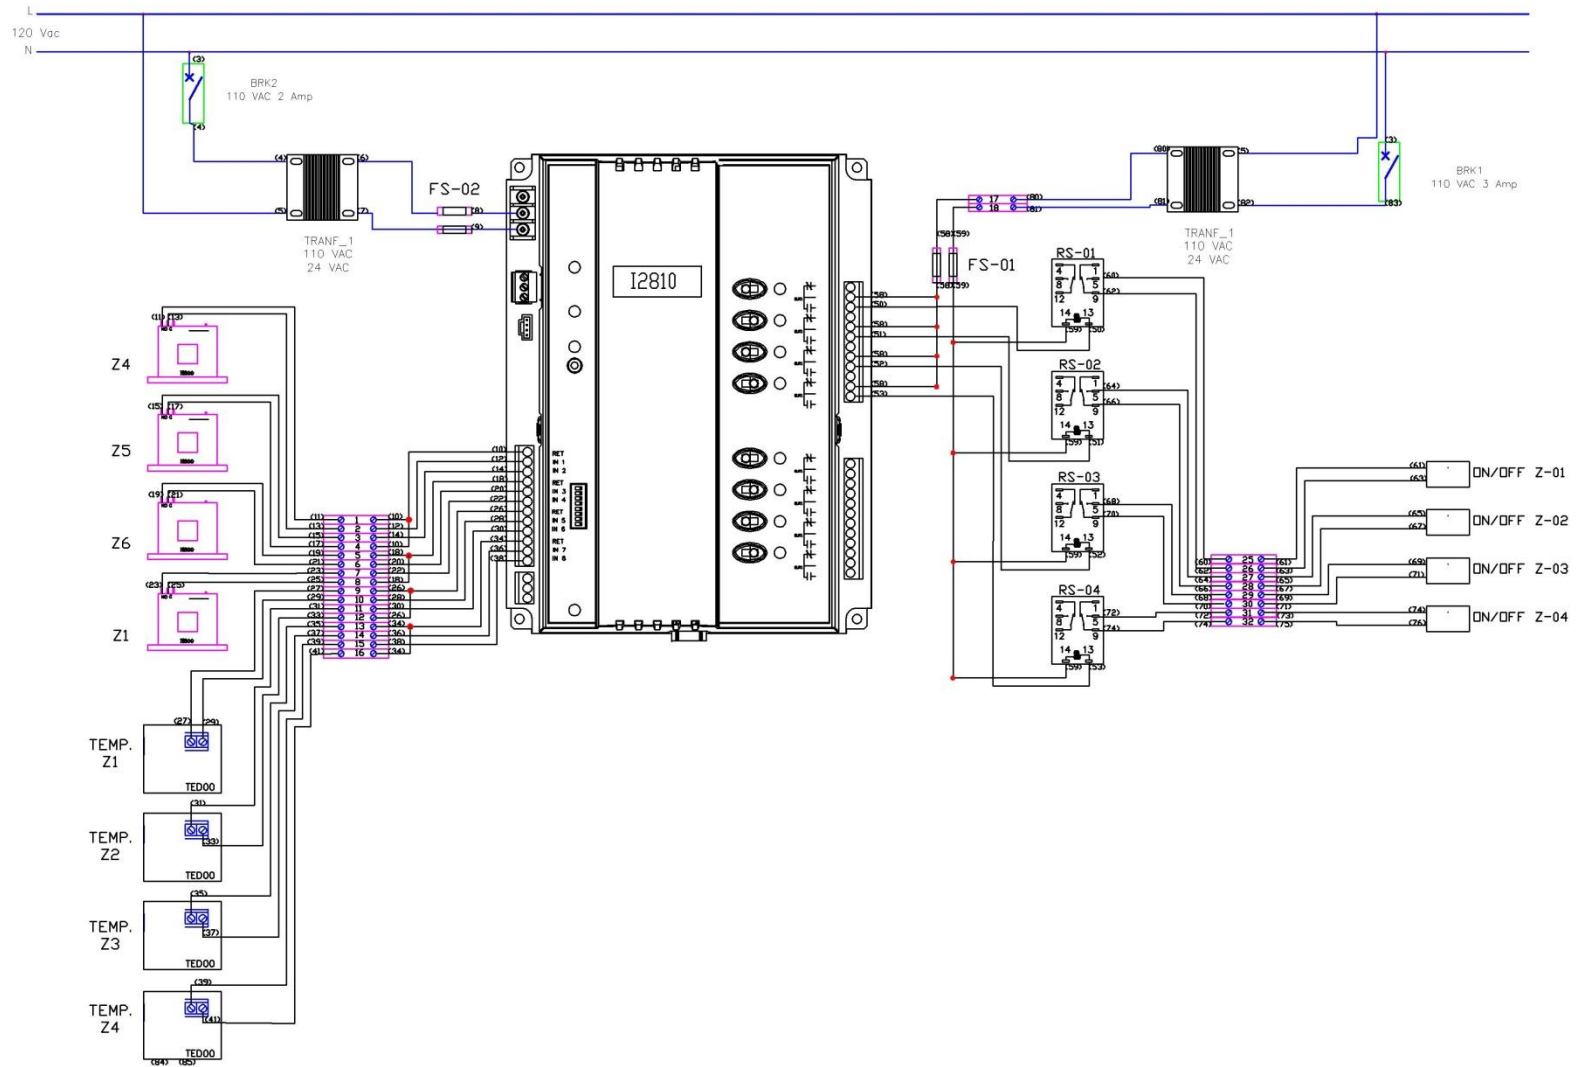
Plano de conexiones eléctricas Tablero UPB J 4 piso Torre Sur
